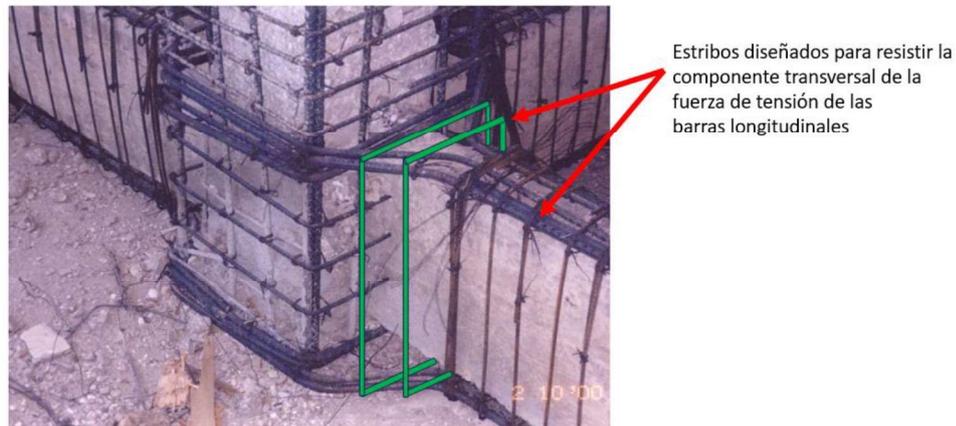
Doble del refuerzo longitudinal en uniones viga-columna encamisadas con concreto reforzado.
